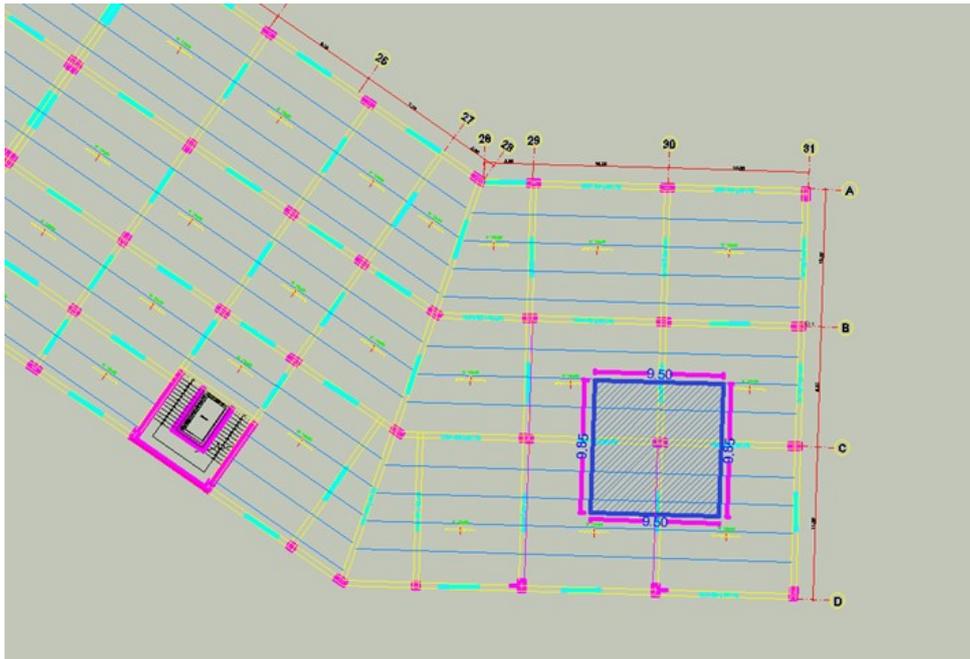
Pre – Dimensionamiento de Vigas Sector Restaurante – Servicios Generales
